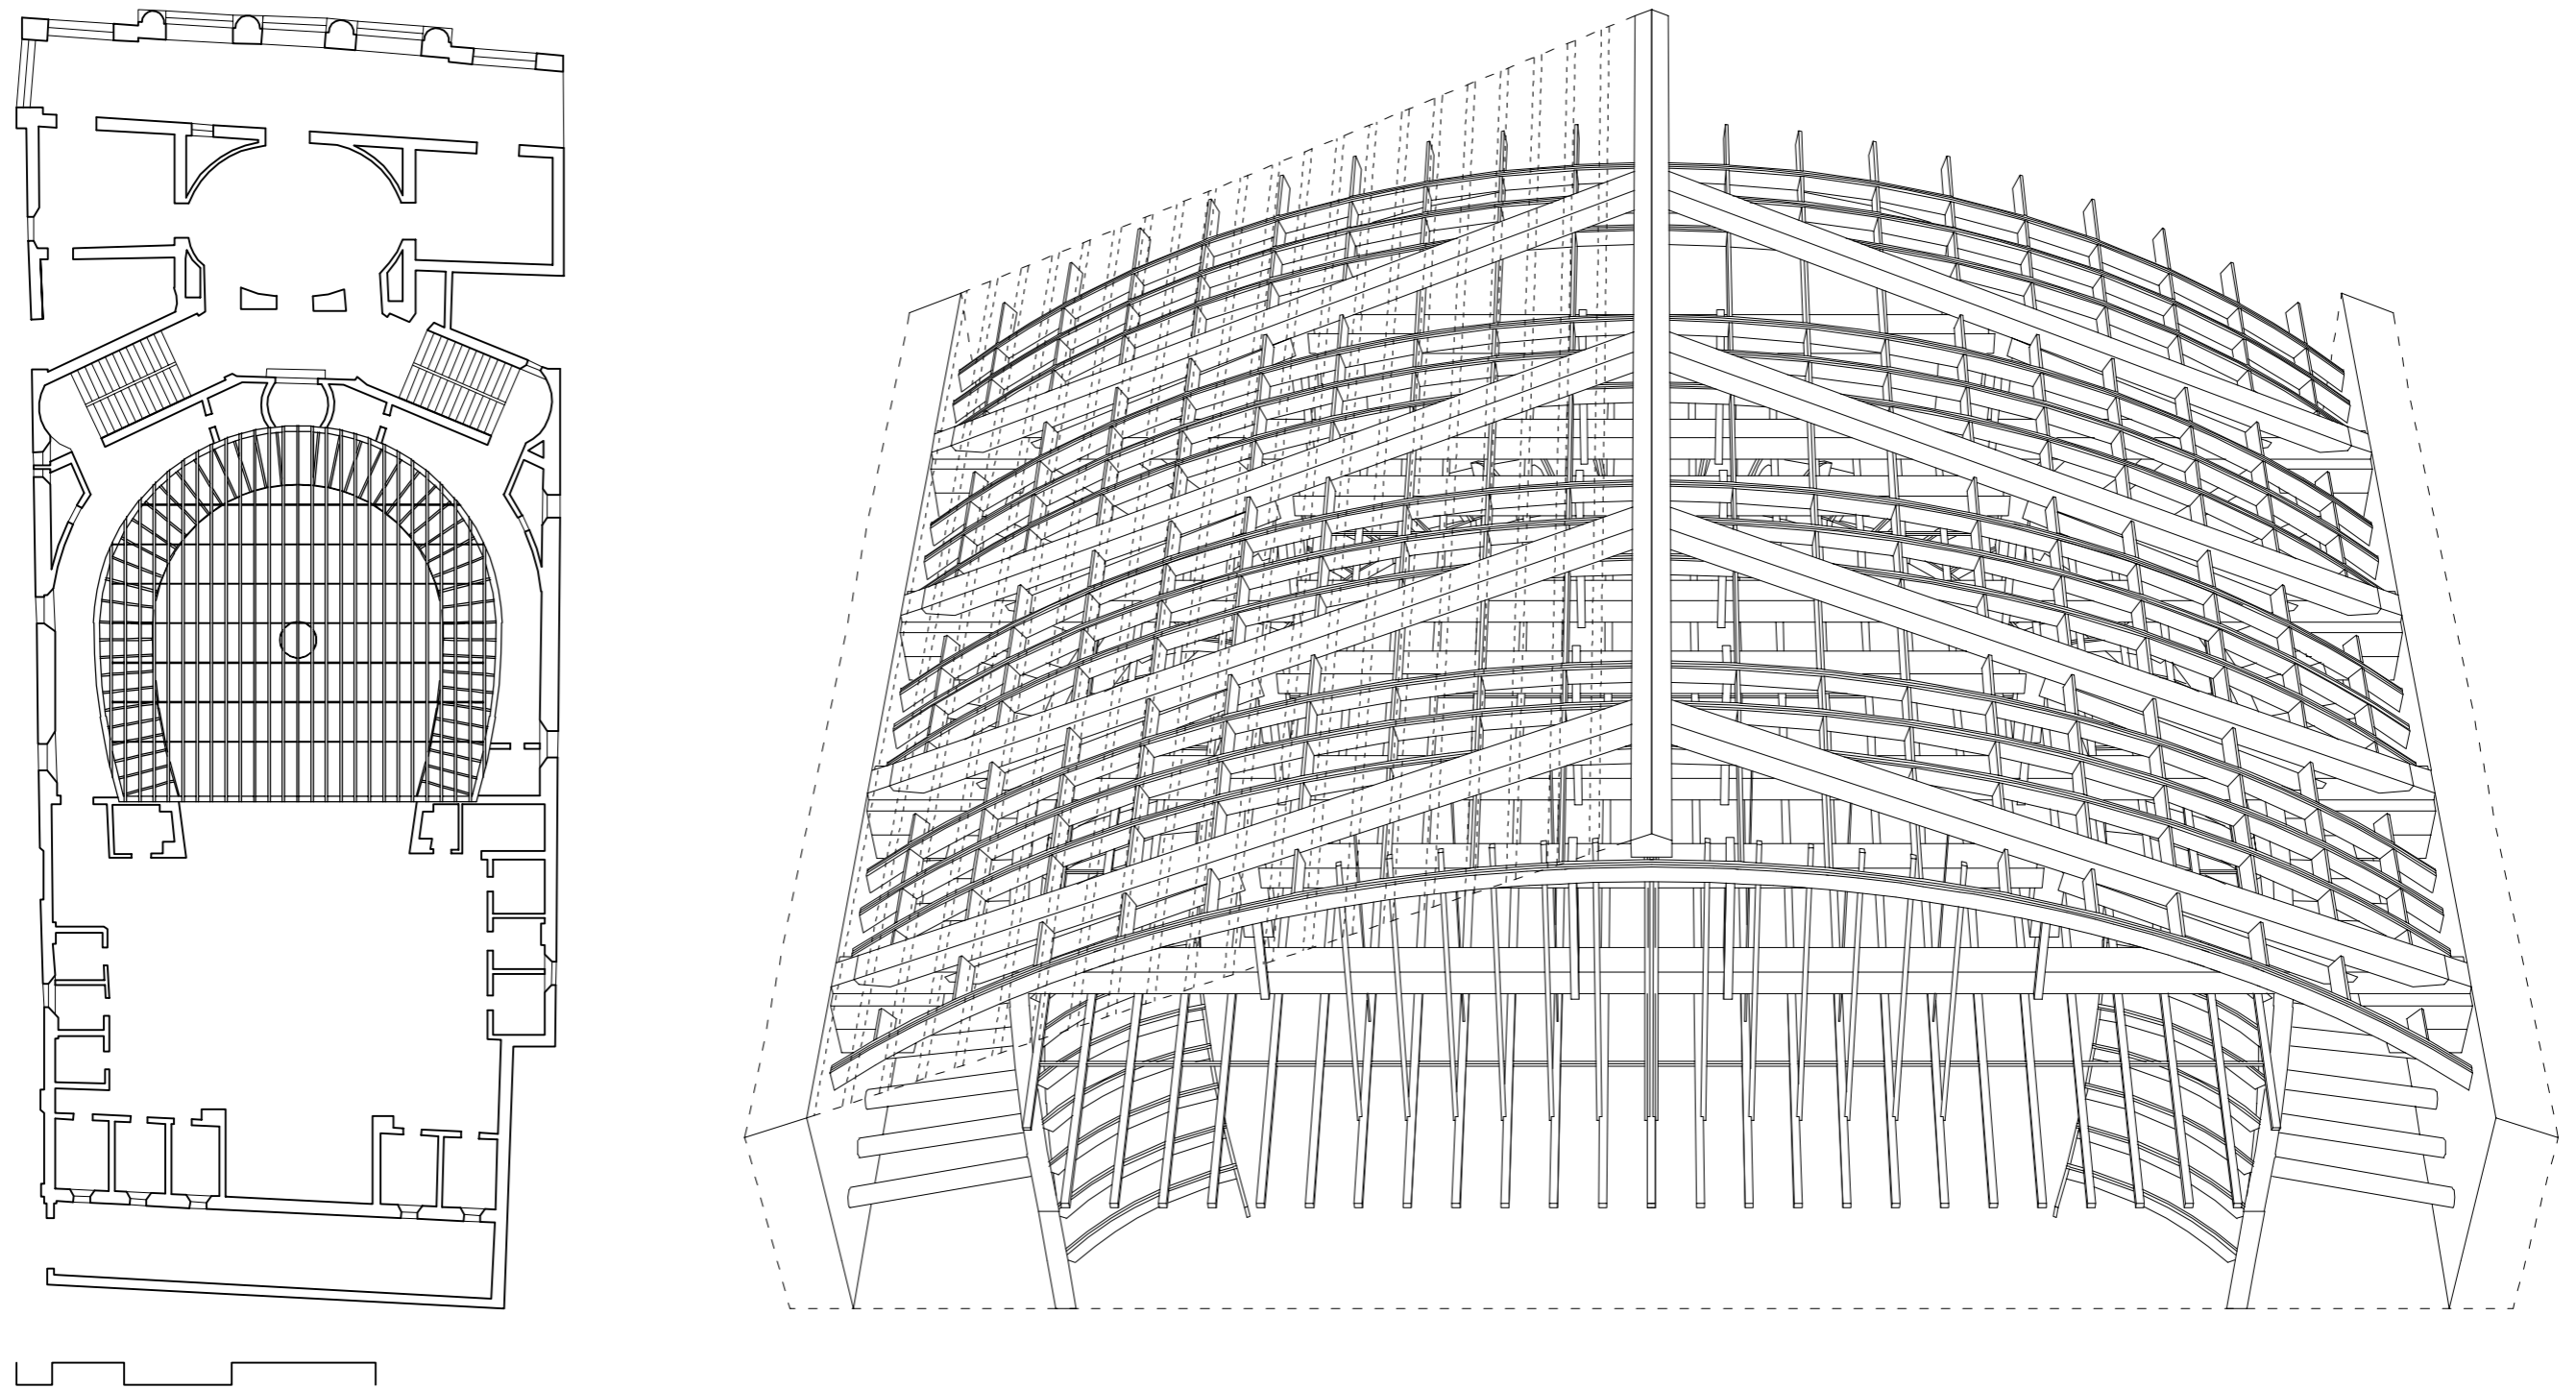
Teatro “Giuseppe Borgatti” di Cento. Pianta del primo ordine di palchi (ridisegno) con proiezione del plafone; rappresentazione prospettica del sistema di copertura della sala.
